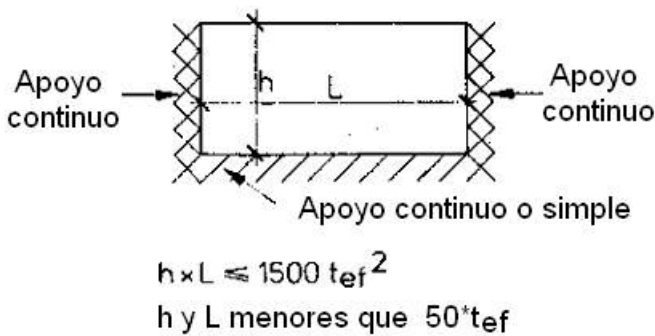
Muro con tres apoyos – 2 o más continuos.
